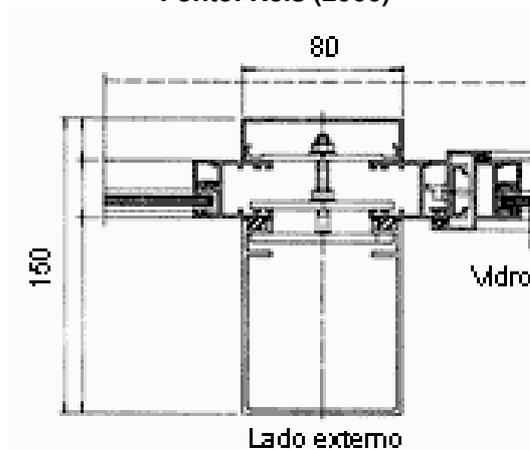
Fachada-cortina convencional: as colunas estruturais da fachada encontram-se no lado externo e o vidro fica totalmente encaixilhado
